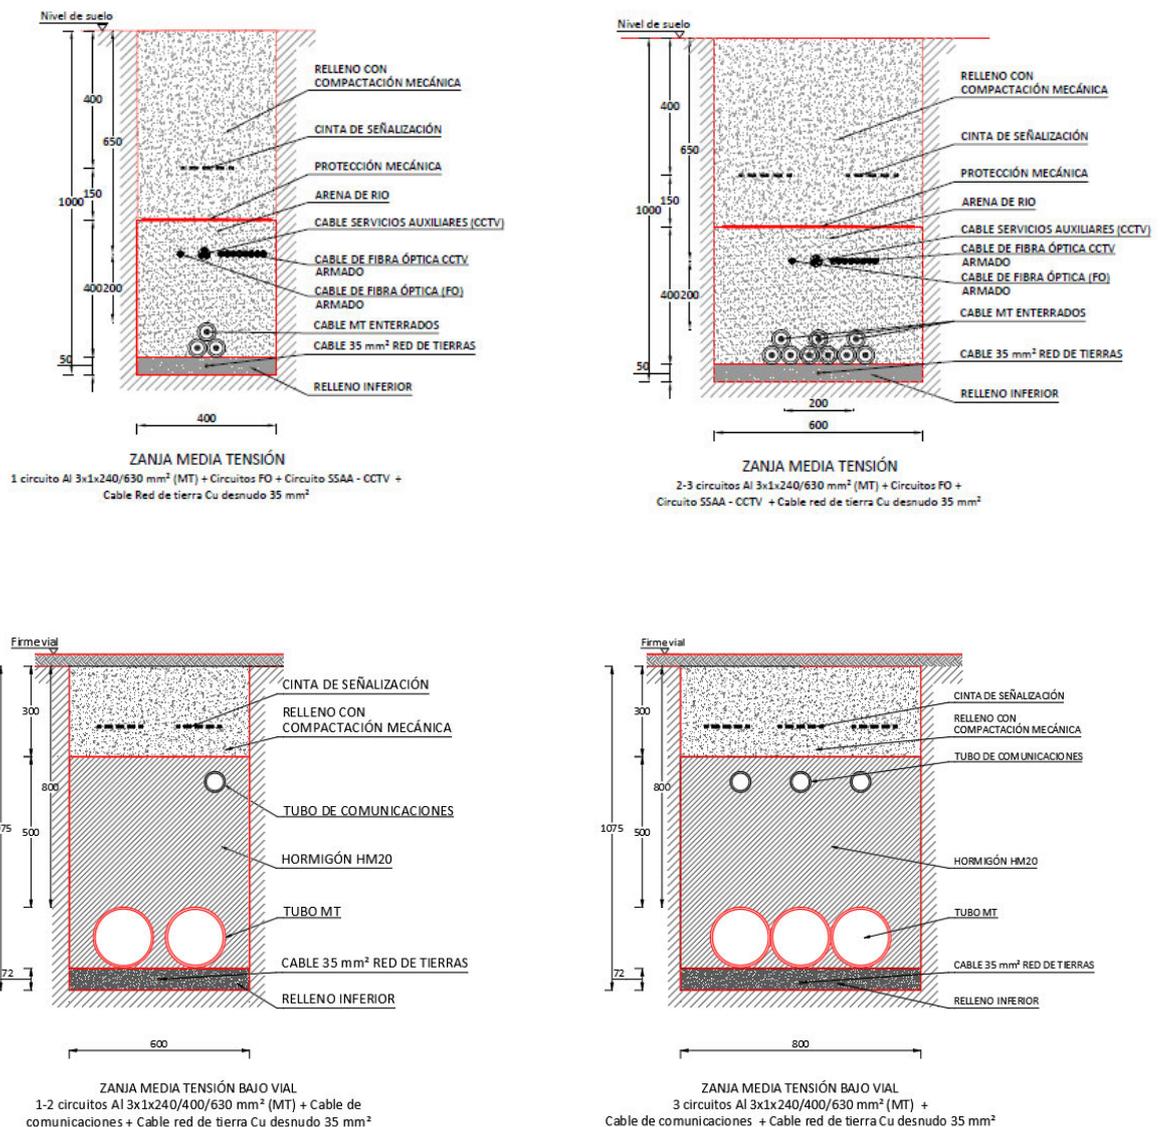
Detalles de zanjas subterráneas previstas
